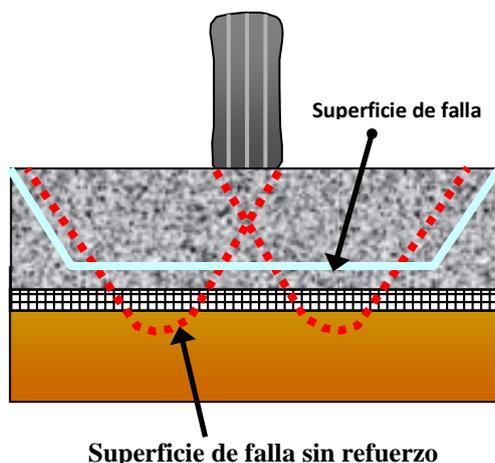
Mejoramiento Capacidad Portante (Fuente: Use of Geogrids in Pavement Construction. USACOE ETL 1110-1-189)
